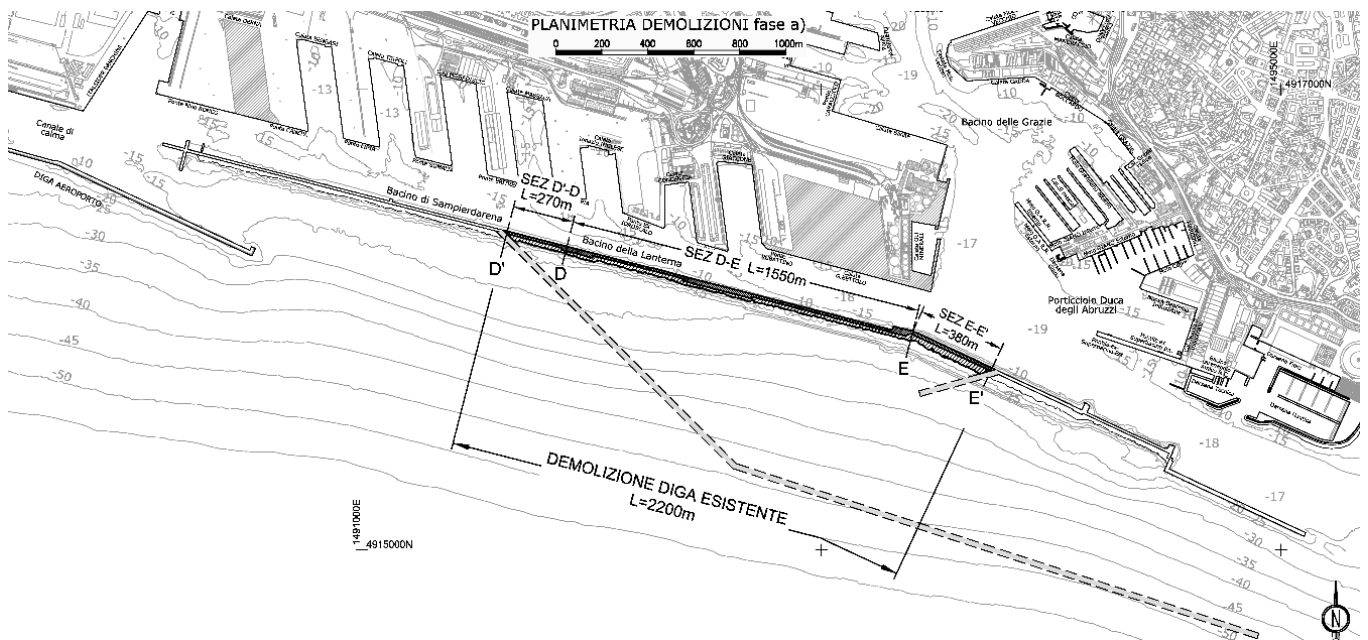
PLANIMETRIA DELLE DEMOLIZIONI PREVISTE IN FASE A)
